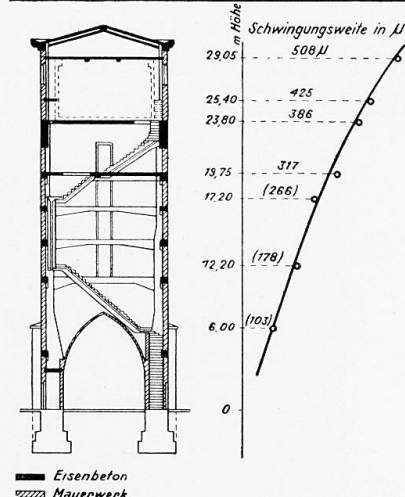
Château d'eau-Observatoire à Babenhausen — Wasser- u. Aussichtsturm in Babenhausen — Water tower and belvedere in Babenhausen.
